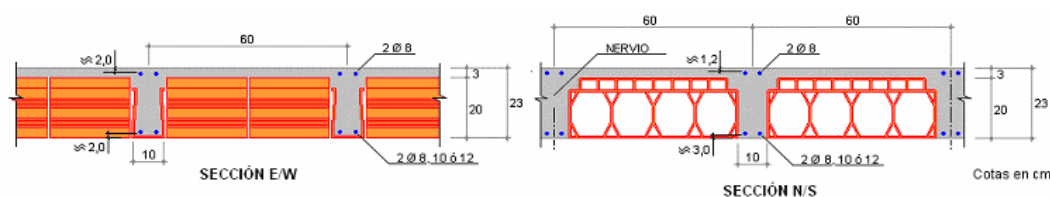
Forjado tipo del edificio en las plantas de oficinas
